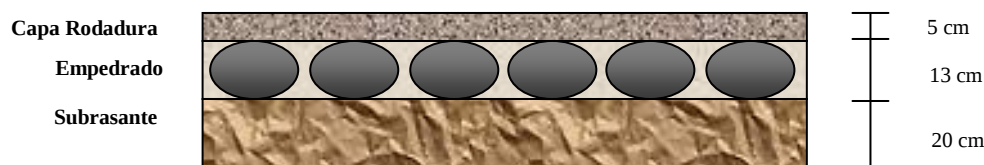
Espesores actuales de las Capas del Pavimento sobre Empedrado Fuente:
